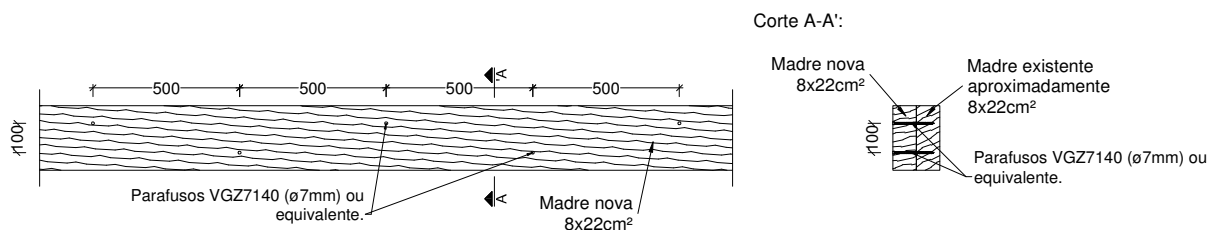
Pormenor tipo de ligação entre madre existente e reforço (sem escala).
